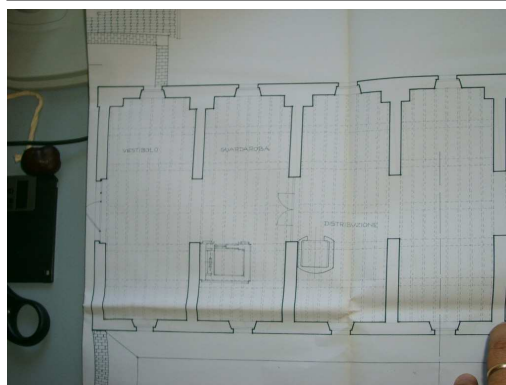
progetto SBAPL-1° cortile fabbricato est-piano 2°- stralcio zona
